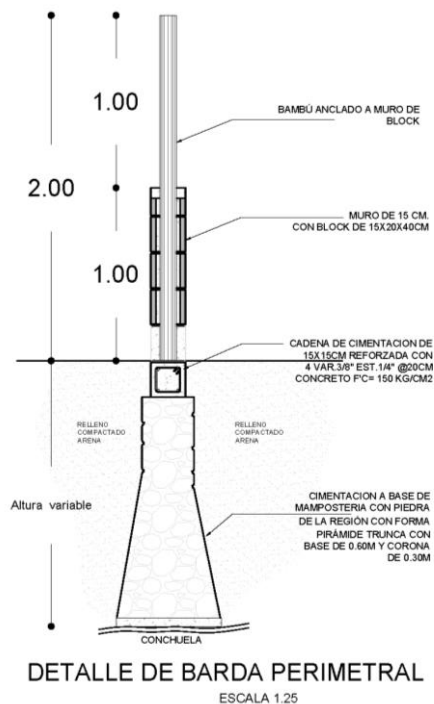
Diagrama del detalle de la barda perimetral a instalar.
